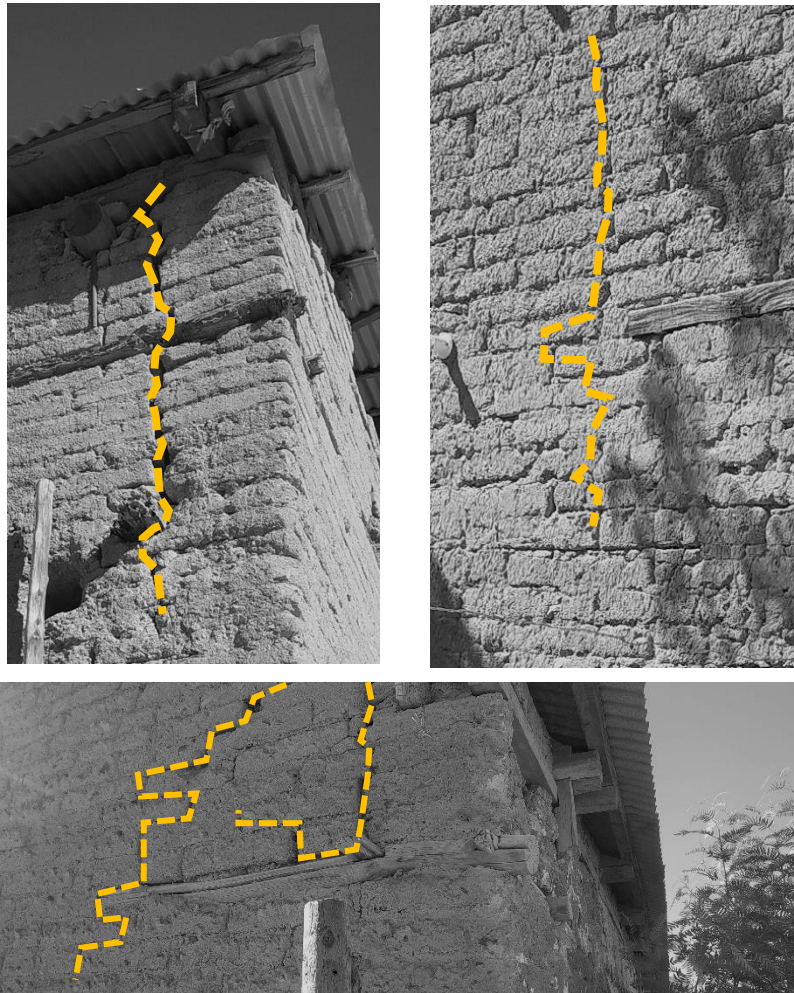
Fisuras y grietas comunes asociados al "dispositivo DC".
